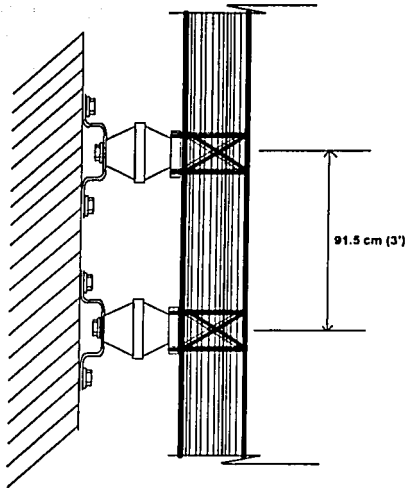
Separación entre Soportes de Fijación del Cable Vertical.
